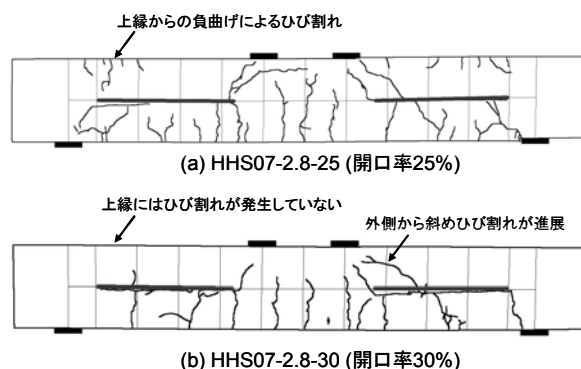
開口率が破壊前のひび割れ状況に及ぼす影響
